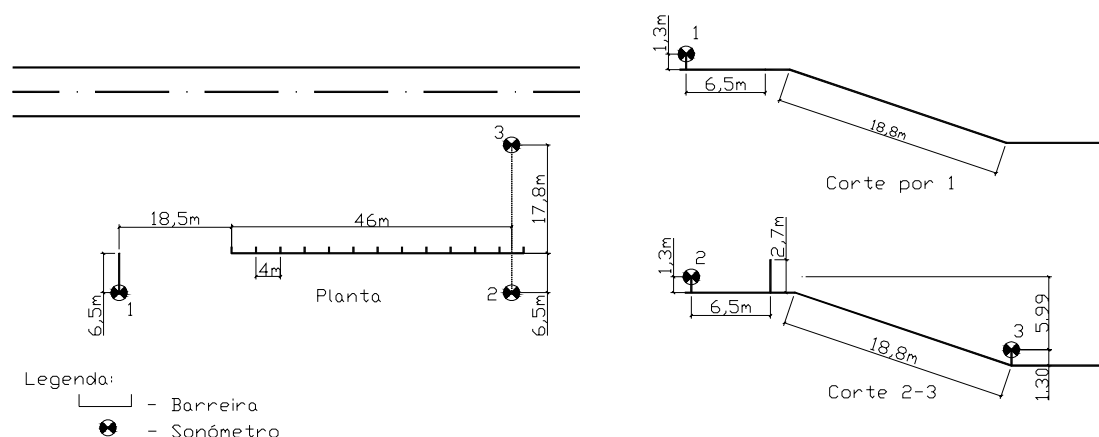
Localização dos equipamentos de medição em planta e em corte no caso de estudo 3.
